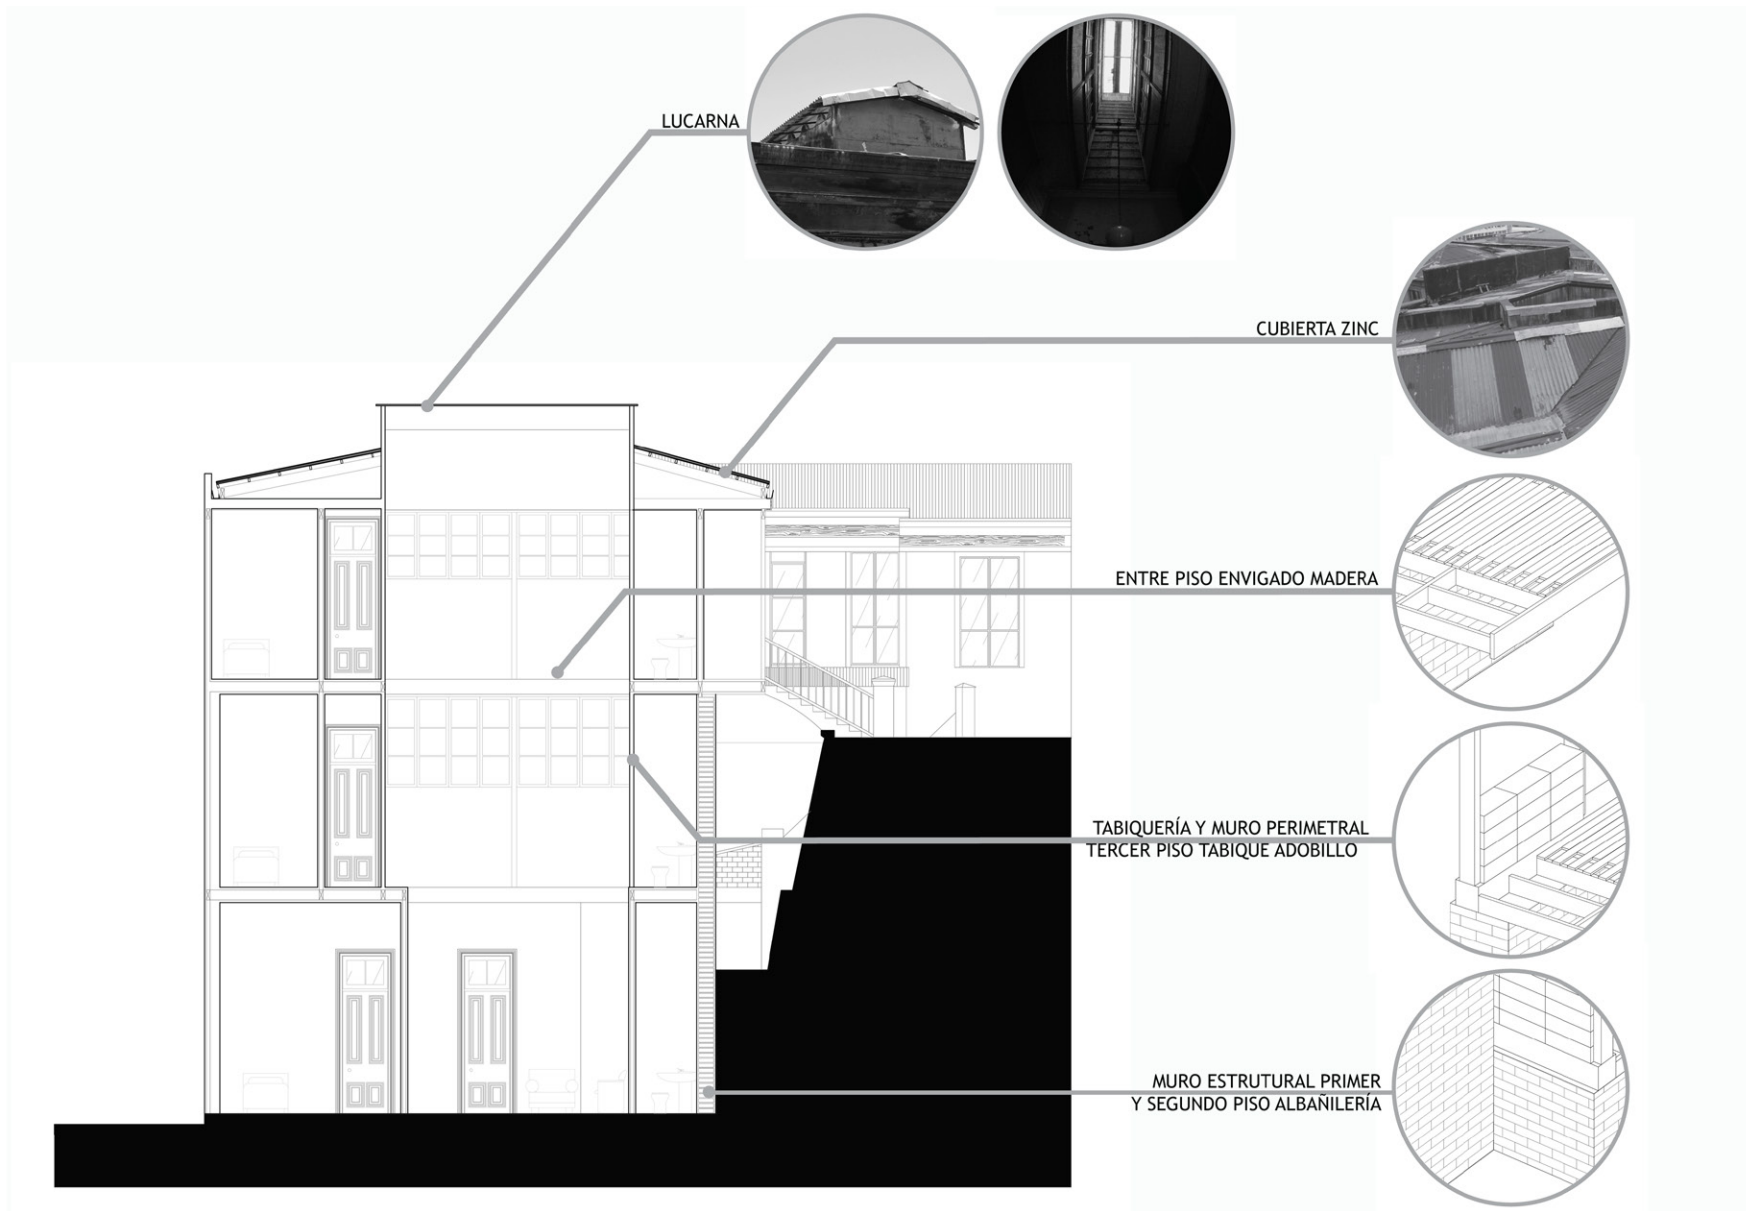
| Corte tipo del inmueble sistema constructivo | Elaboración propia
